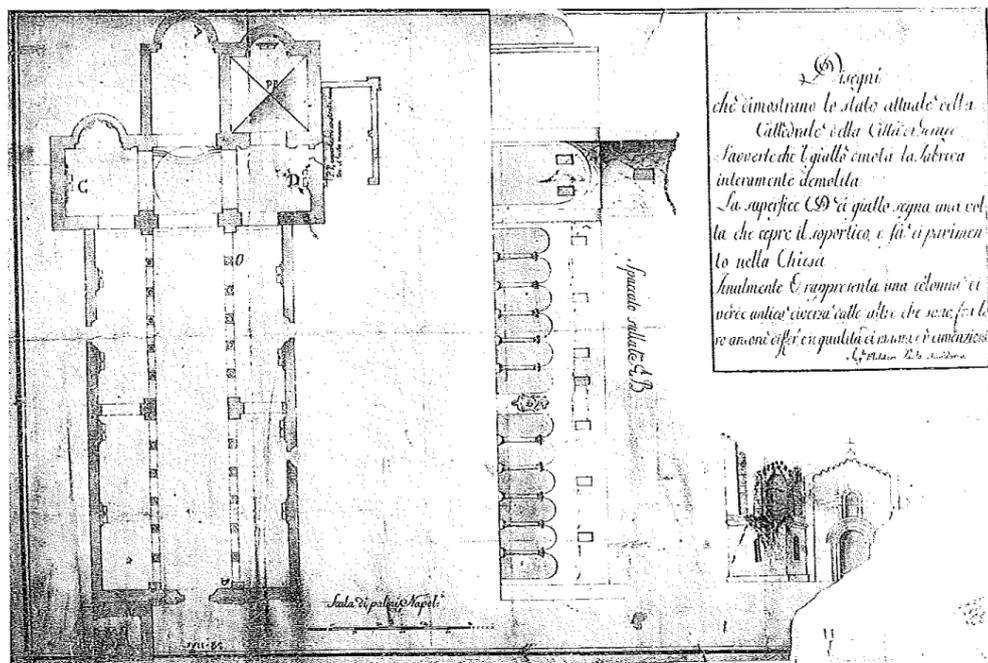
P. Scandurra, Pianta, sezione e prospetto della Cattedrale di Gerace
